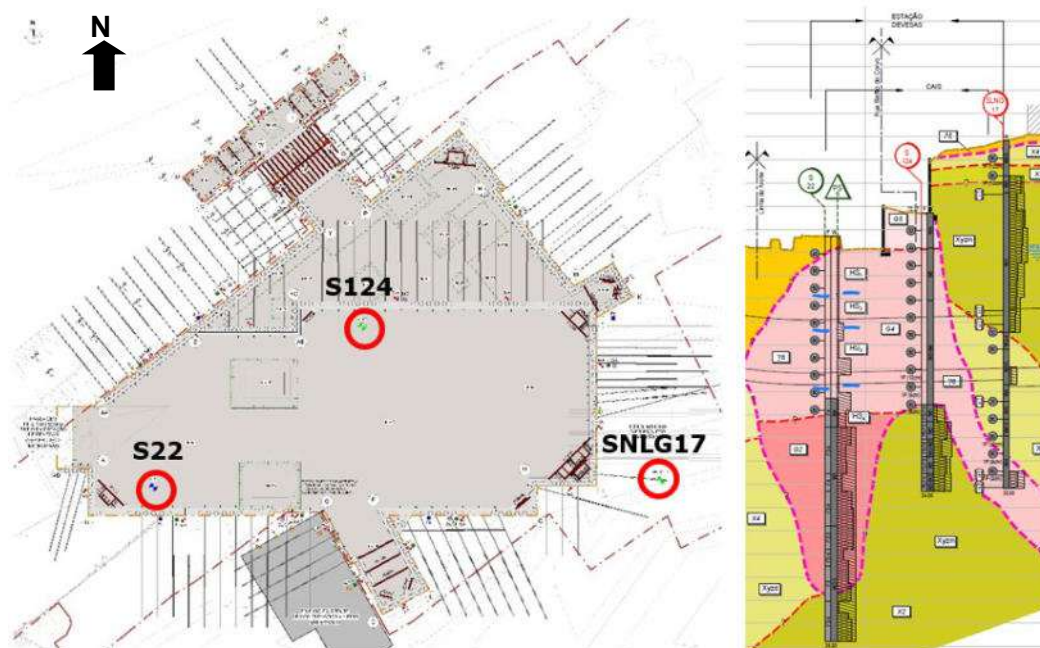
Planta de localização das sondagens e perfil geológico-geotécnico
